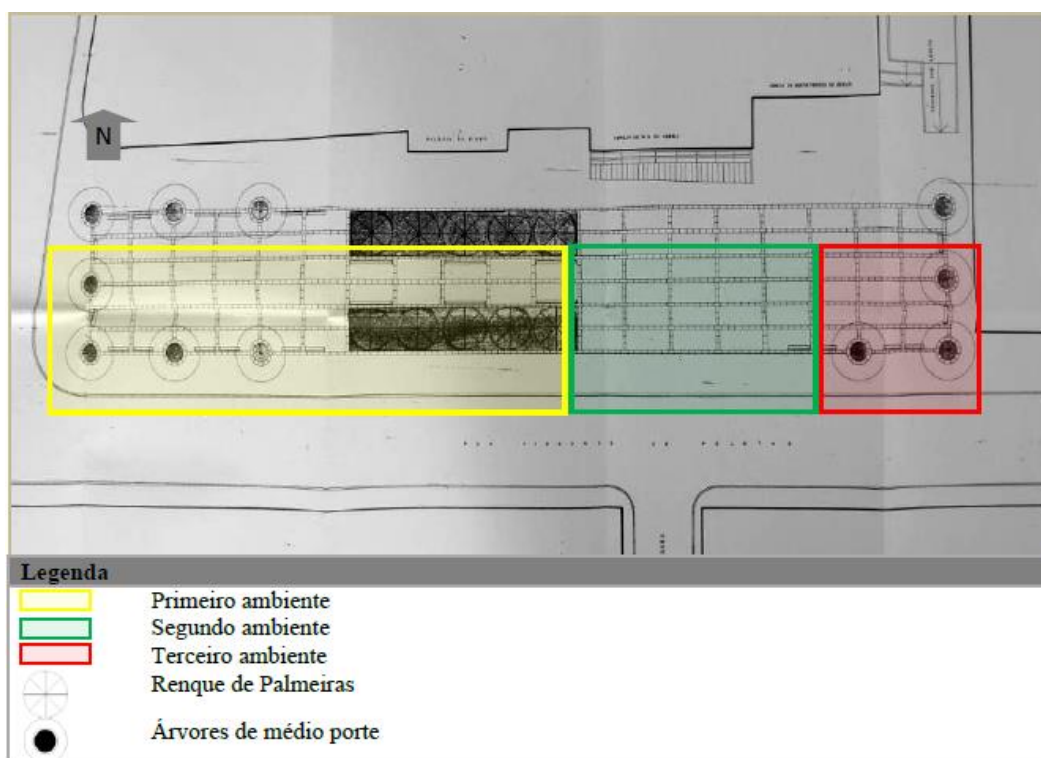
Planta da proposta de revitalização da Praça Dom Adauto em 1988
